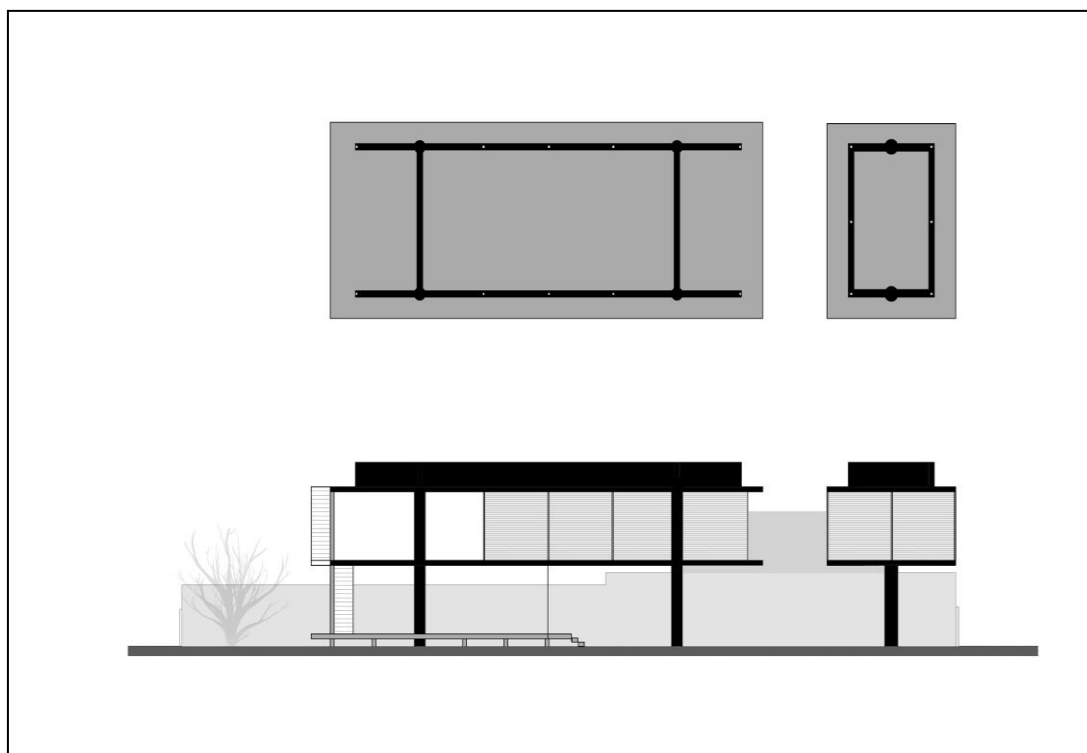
Elevação e cobertura, com elementos estruturais destacados (2).
